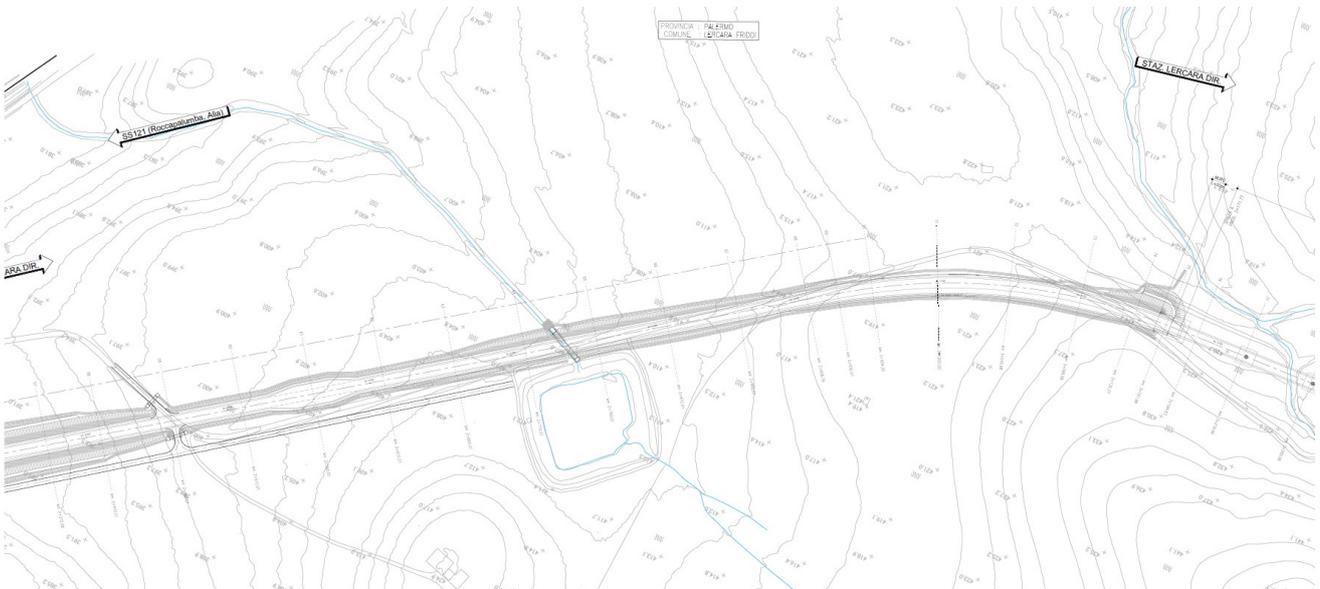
Planimetria di progetto dalla Km 0+000 alla Km 0+750
